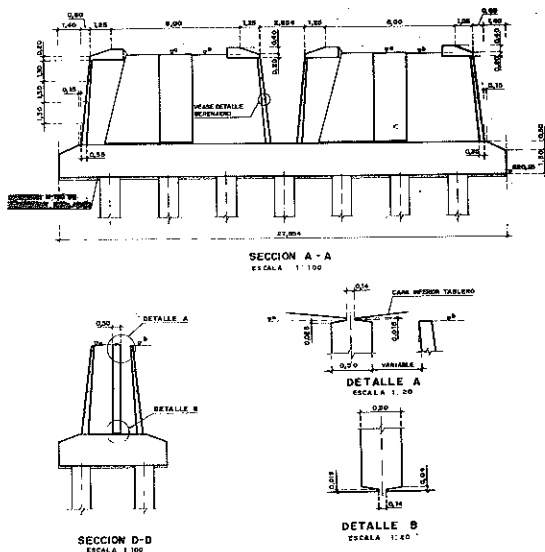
Plano detalle de la Pila - Péndolo - (Secciones).
